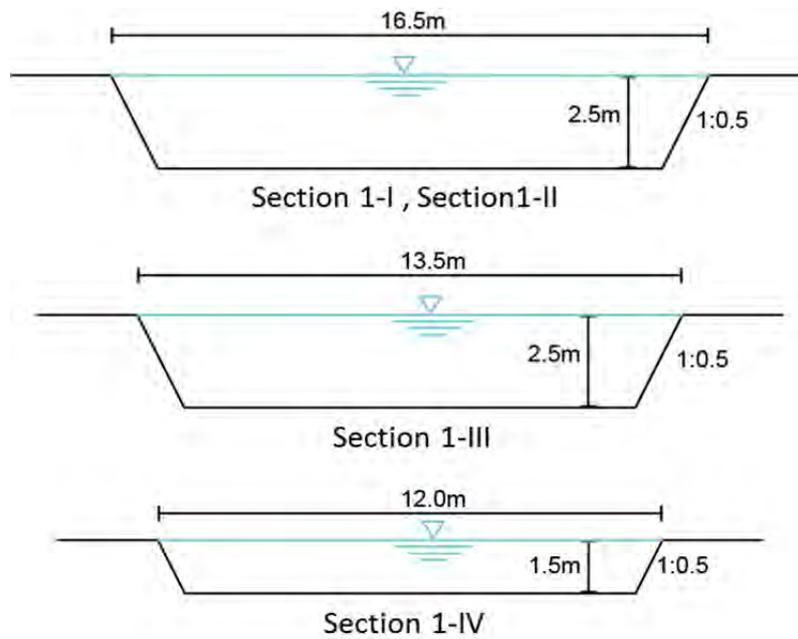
SITU Sidomukti 下流区間 計画横断面図
